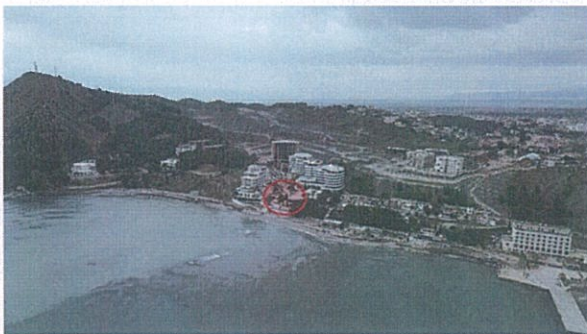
Foto e zonës pranë sheshit të ndërtimit
